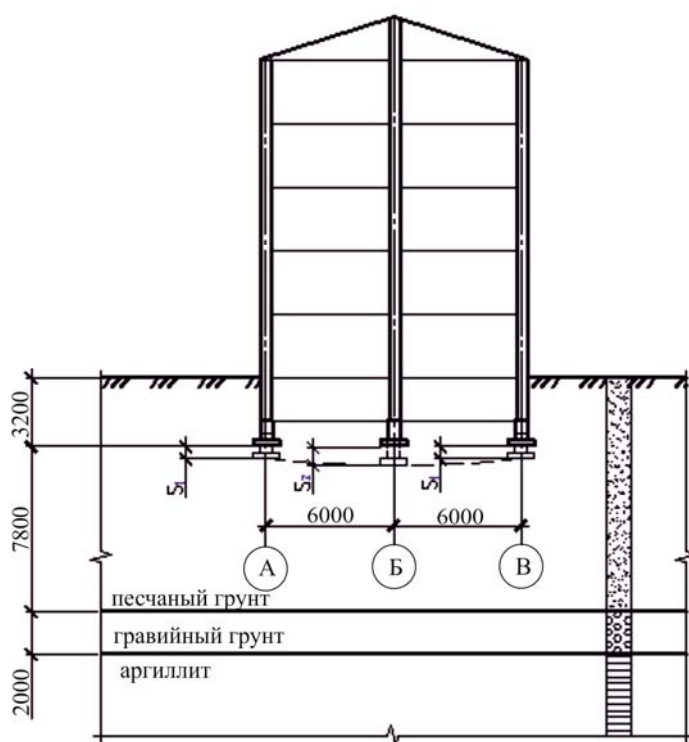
Схема пятиэтажного здания для расчета относительной осадки под фундаментами несущих продольных стен
